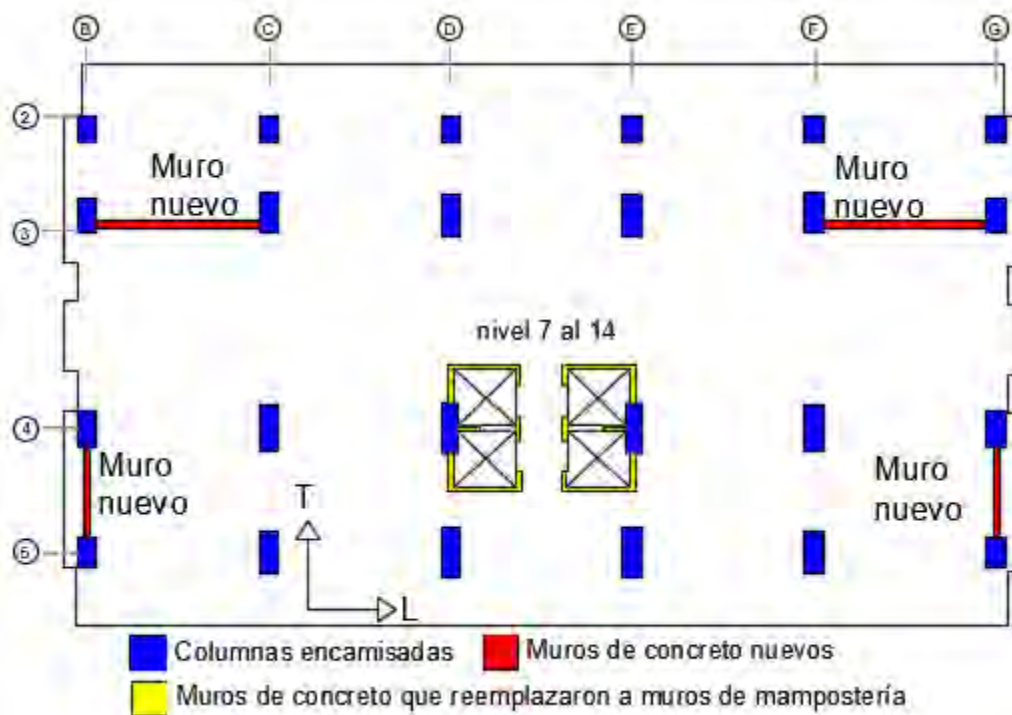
Elementos estructurales reforzados en los niveles del 7 al 14
